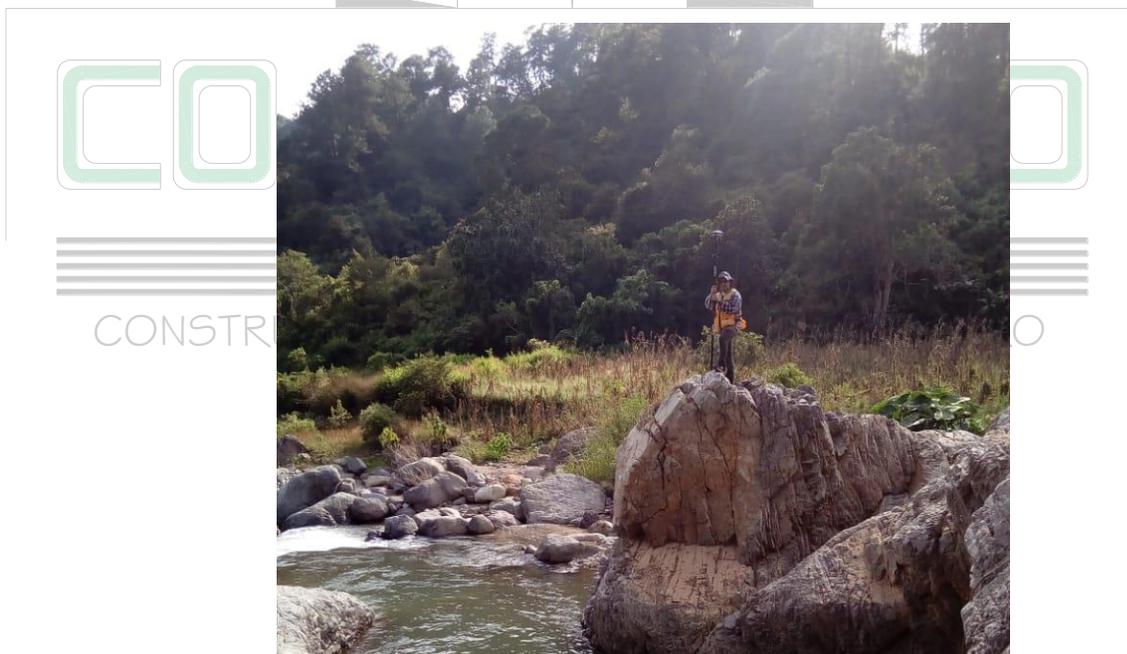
Levantamiento topográfico en la zona de proyección del puente vehicular
